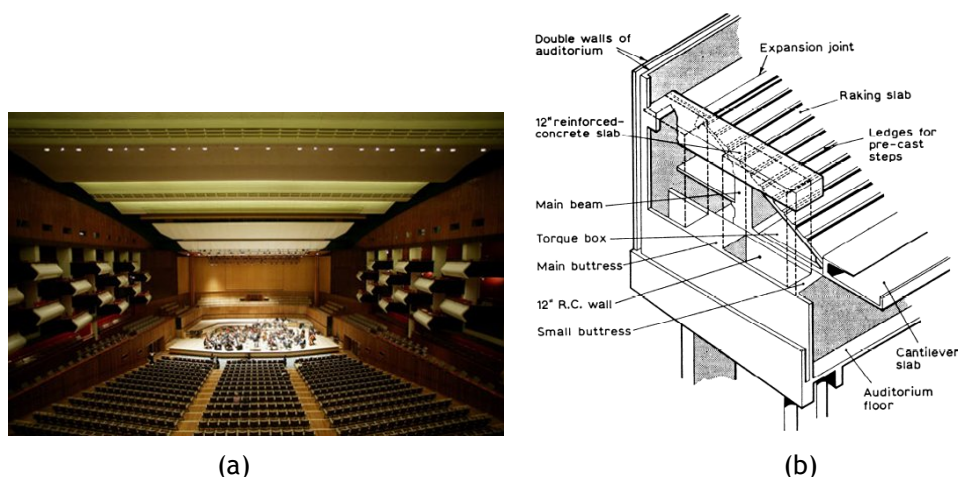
Vista geral e do caixão triangular para suporte da laje em consola no *Royal Festival Hall* [56]
